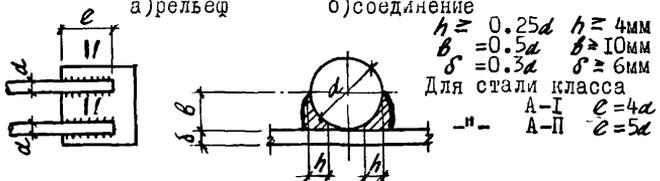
Соединение анкеров с пластиной внахлестку ручной электродуговой сваркой
